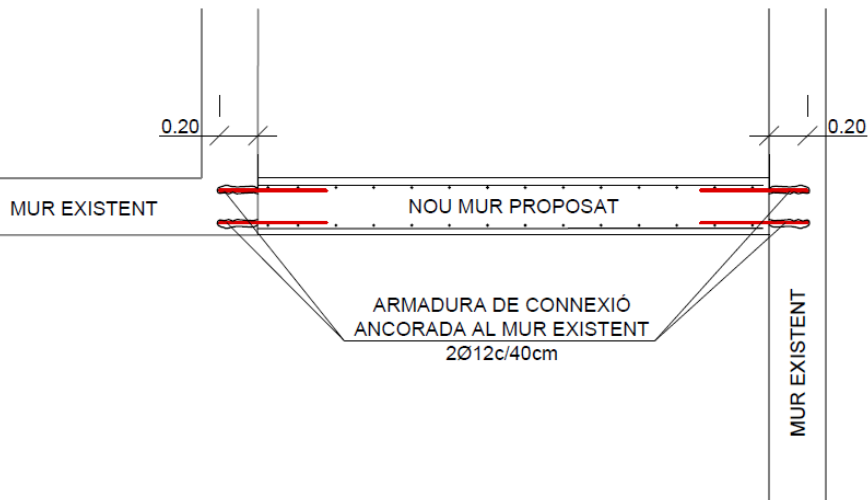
Detall de l'armadura de connexió de les noves estructures amb les existents.
